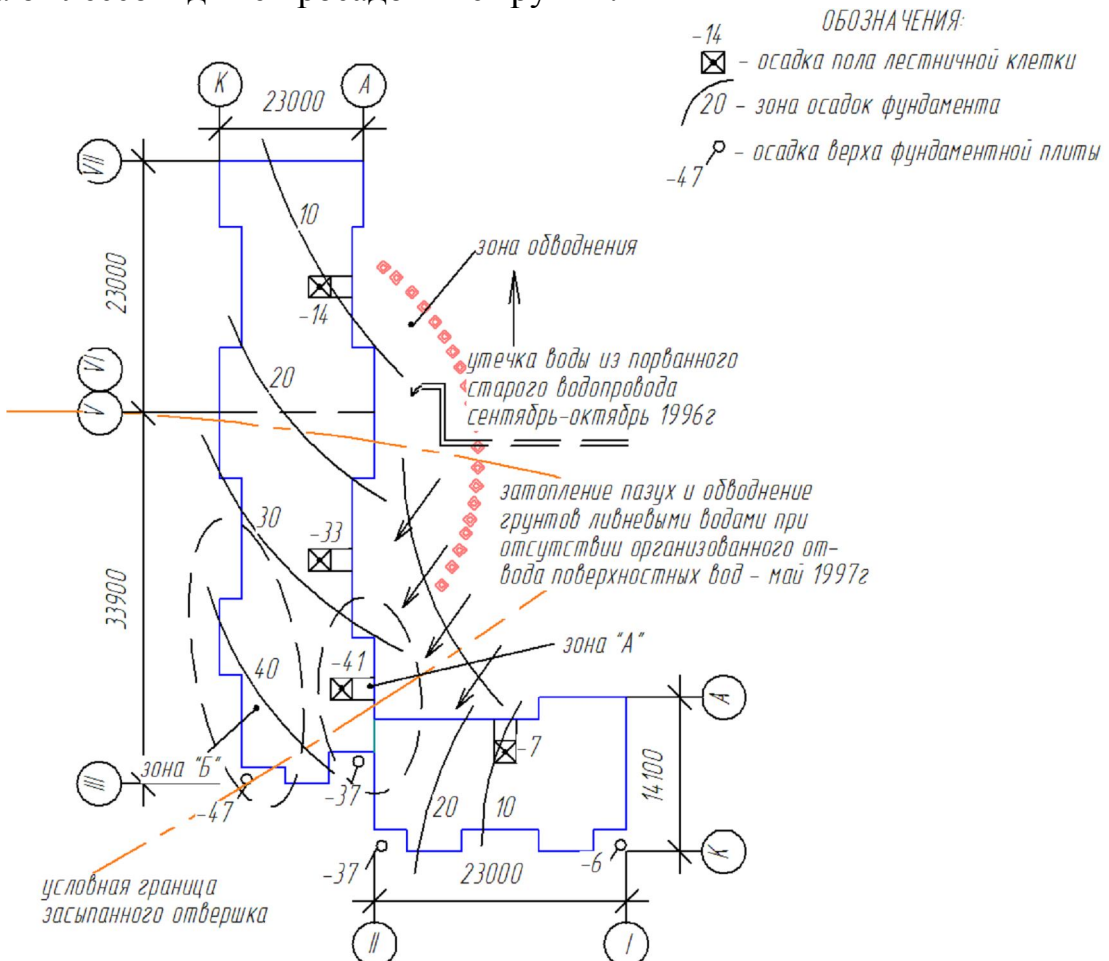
Схематичный план здания с указанием зон развития осадок отдельных частей здания, зон риска «А» и «Б» и положение от вершка оврага
